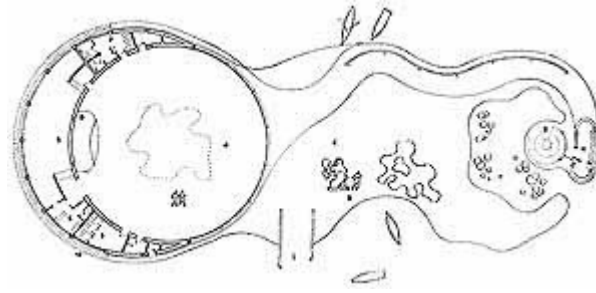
Planta baixa da Casa do Baile, Pampulha, (1942)
